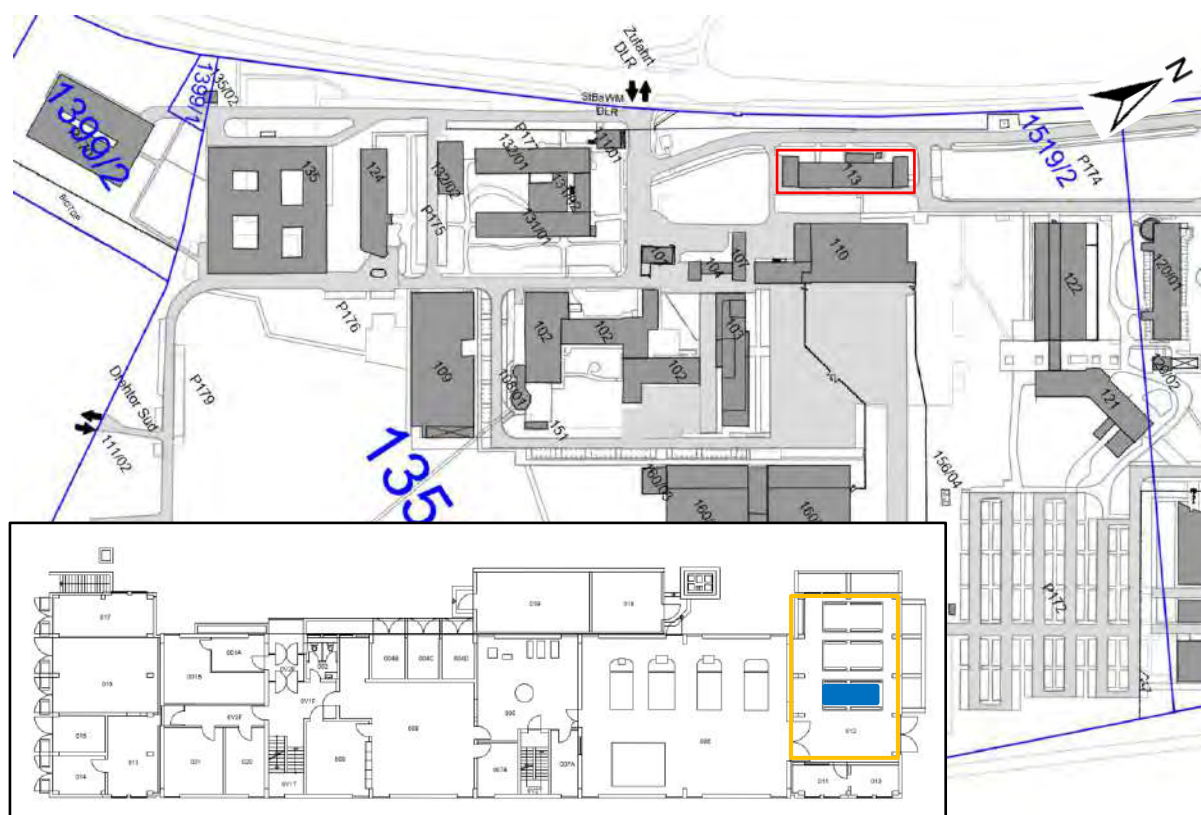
Lage von Gebäude 113 (rot). Im EG-Grundriss Lage des Raumes mit dem Aggregat als orangene Markierung; Lage des Notstromaggregats als blaue Fläche. [23].
